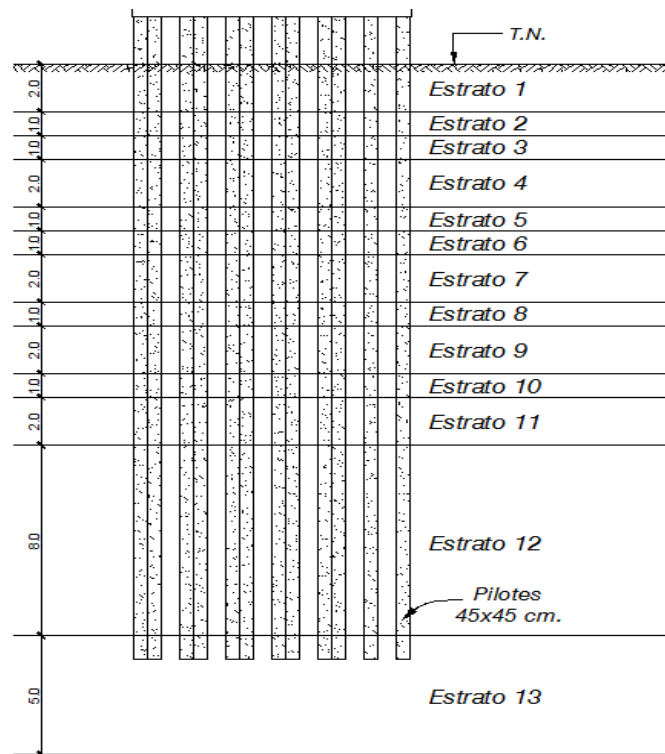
Grupo de pilotes y estratigrafía de la pila P1.
